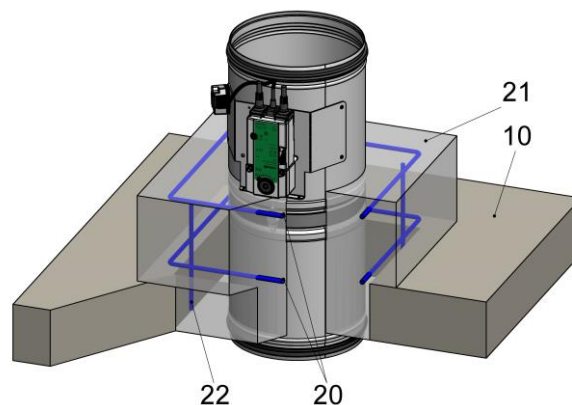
montaggio in soffitti massicci con zoccolo in calcestruzzo
